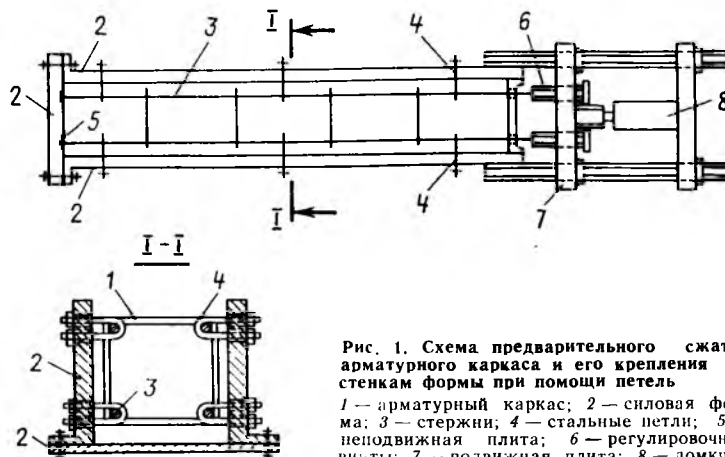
Схема предварительного сжатия арматурного каркаса и его крепления к стенкам формы при помощи петель
